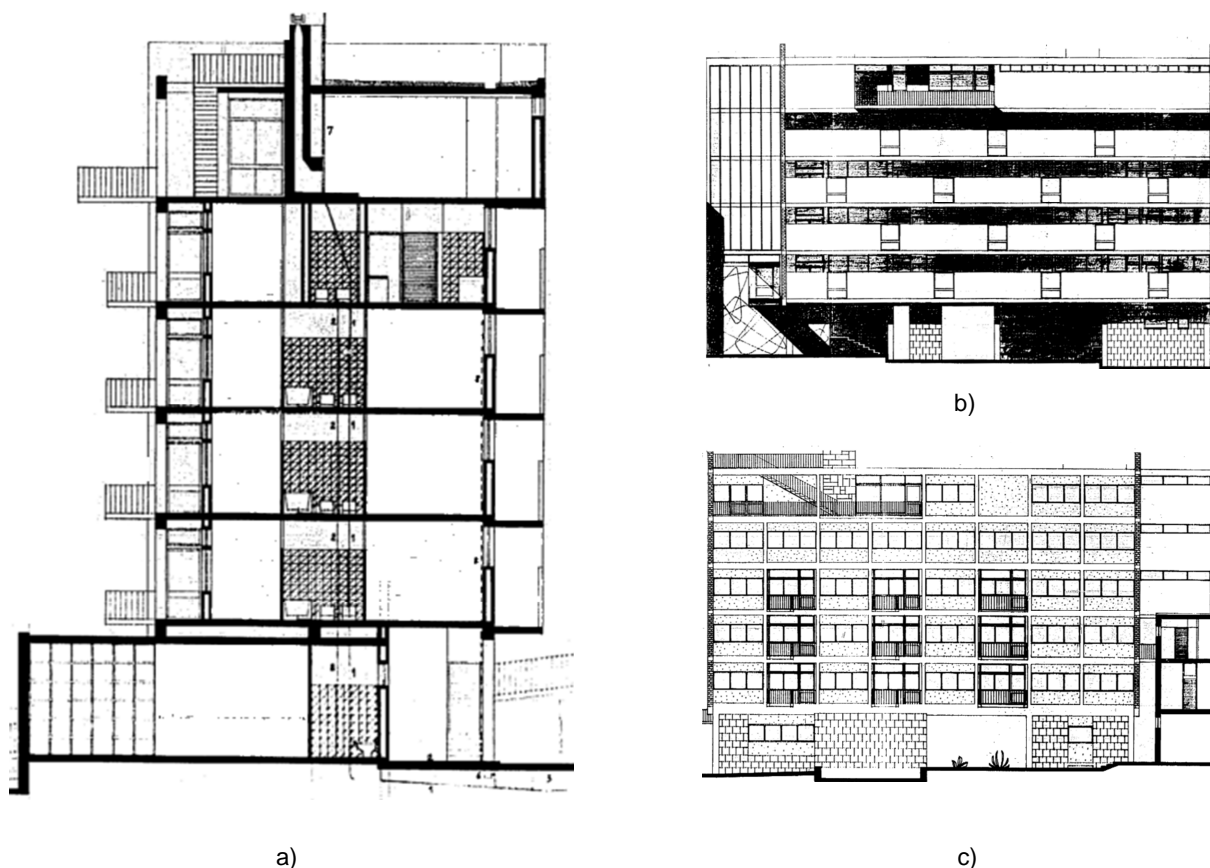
Edifício Parnaso: a) corte, b) fachada posterior e c) fachada principal do projecto de arquitectura.
